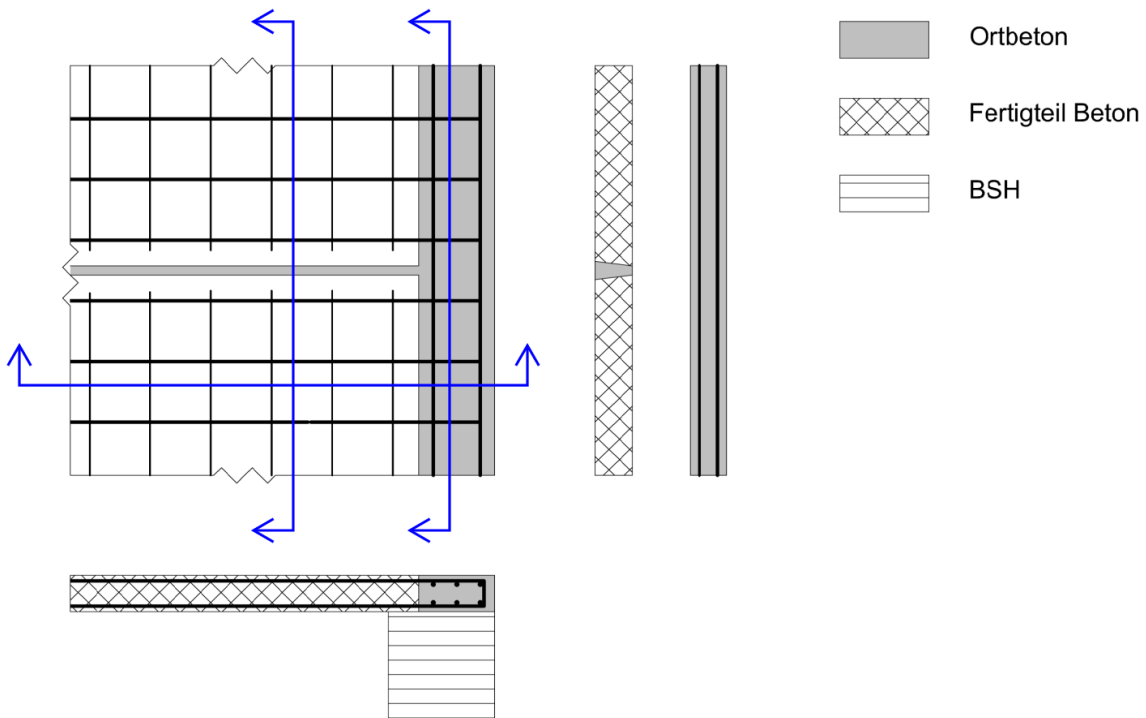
Grundriss und Schnitte: Kopplung der Deckenelemente durch Ortbeton-Ringbalken
